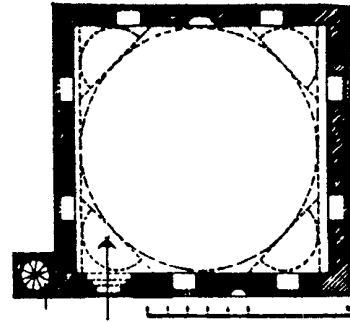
مسقط أفقى لجامع أحمد باشا
